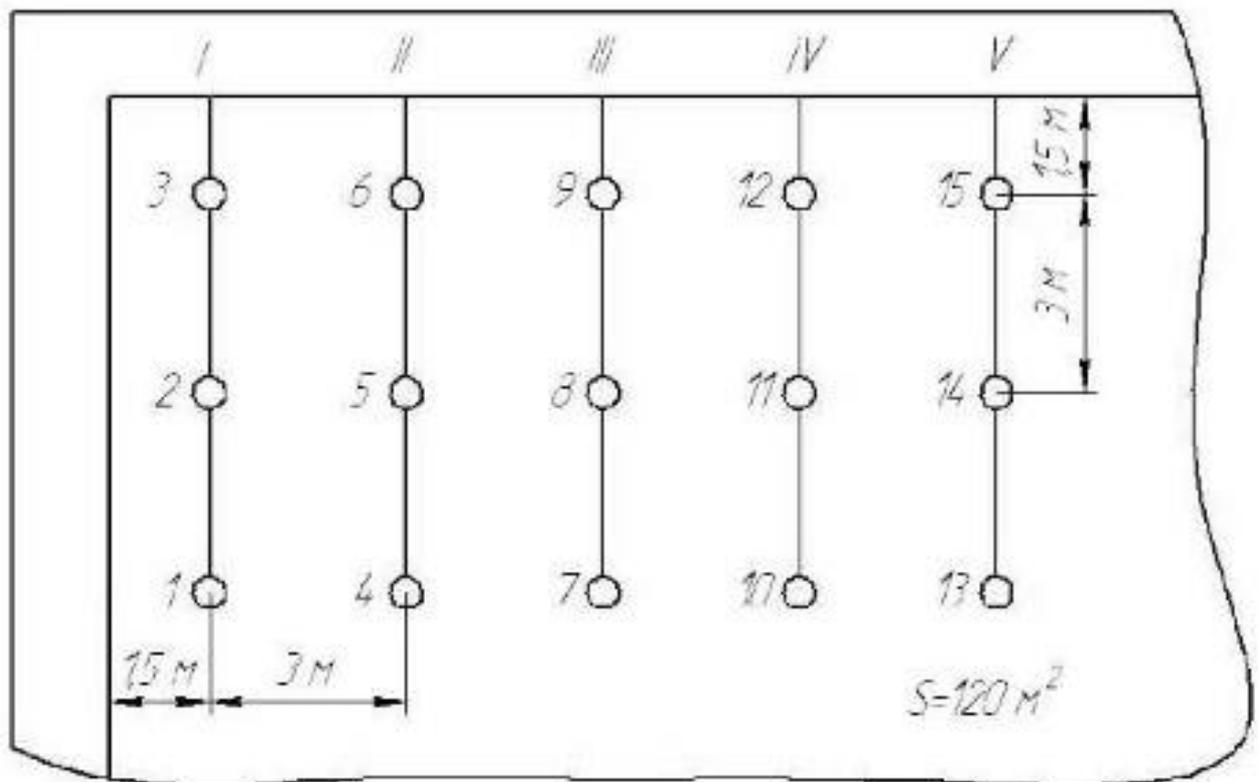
План размещения оросителей на защищаемой площади
